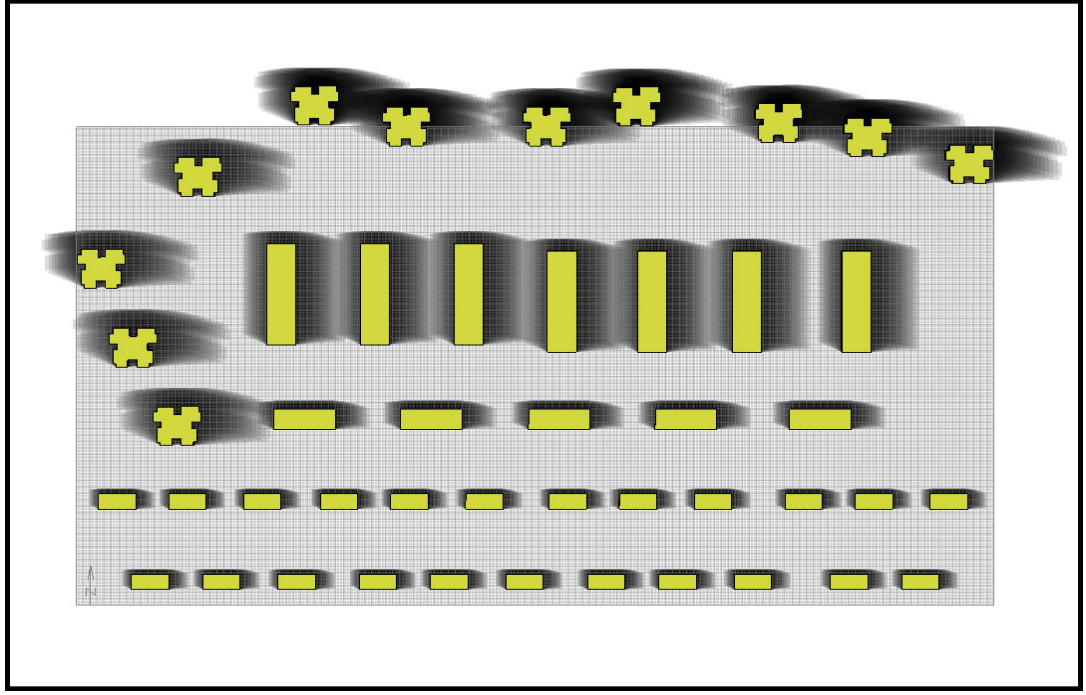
Ataköy 5. Kısım öneri vaziyet planı 2
